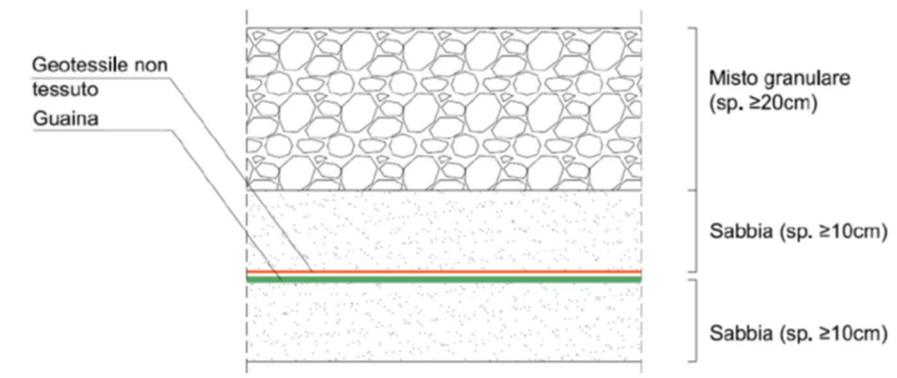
Particolare del pacchetto pavimentazione area "nasone" - Lavori di realizzazione della Piattaforma Logistica- Primo stralcio - Perizia di Variante n. 2
